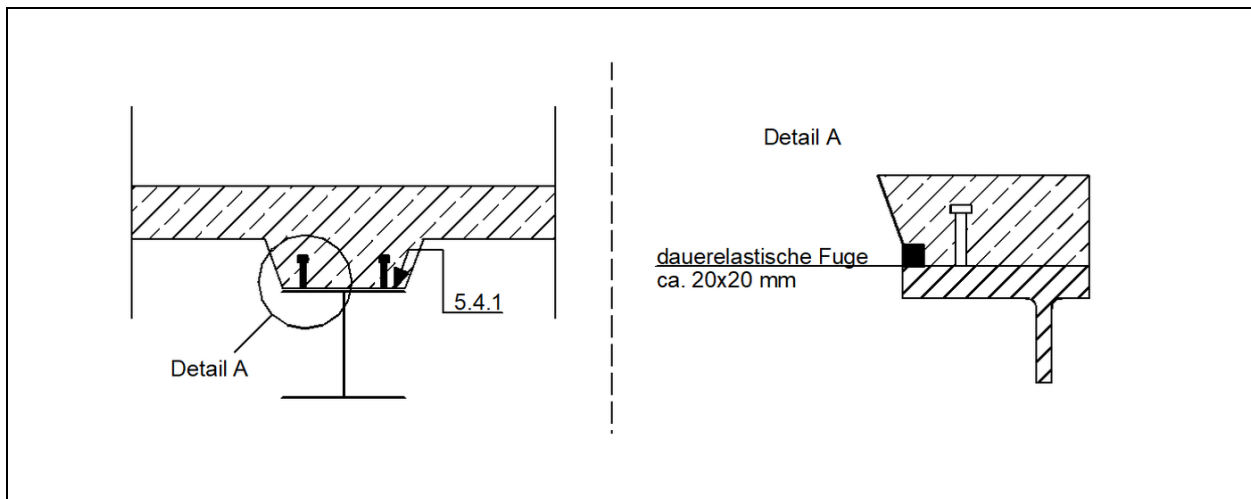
Detailquerschnitt in Verbundbauweise mit Ortbeton
